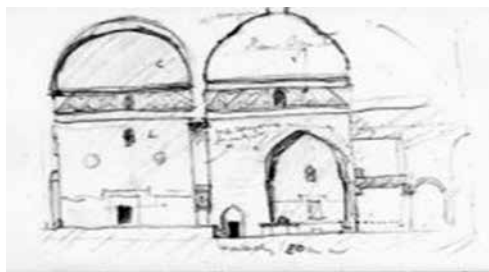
Corte longitudinal Mesquita Verde em Brousse, 1911
